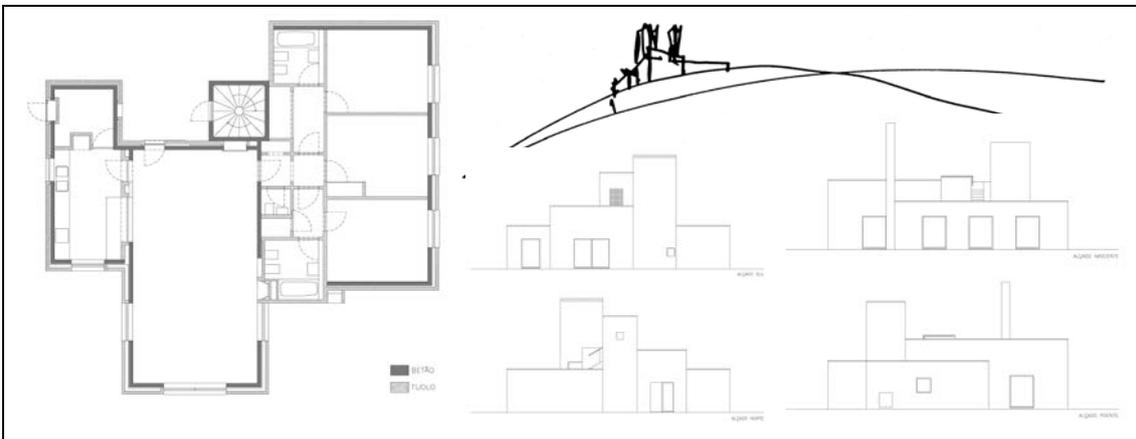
Planta e alçados da Casa de Tavira e esquiço de ESM
